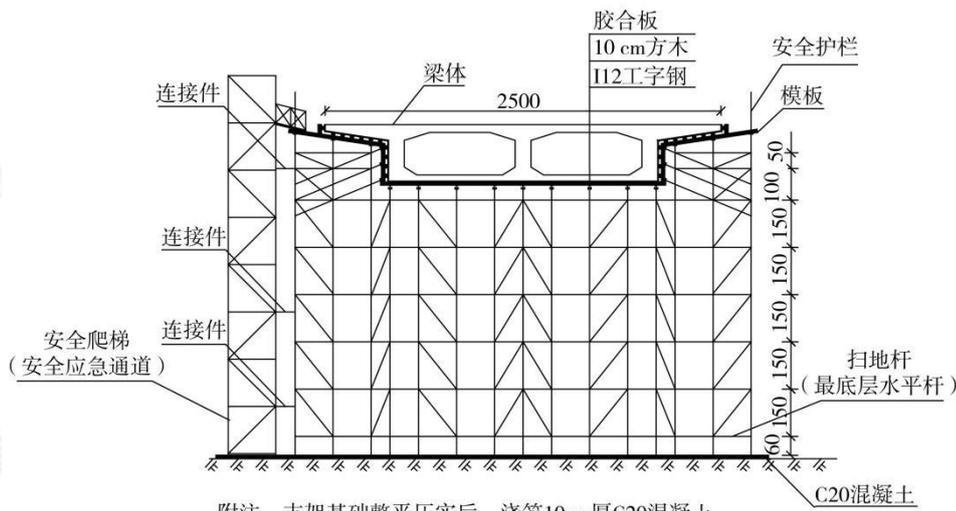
桥梁支架立面示意图（尺寸单位：cm）
